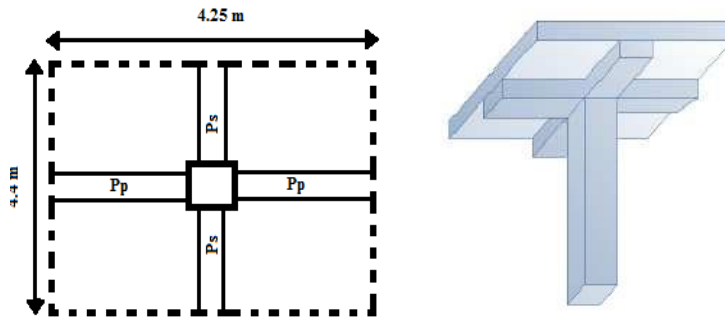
dimension de la section revenant au poteau intérieur le plus sollicité.
